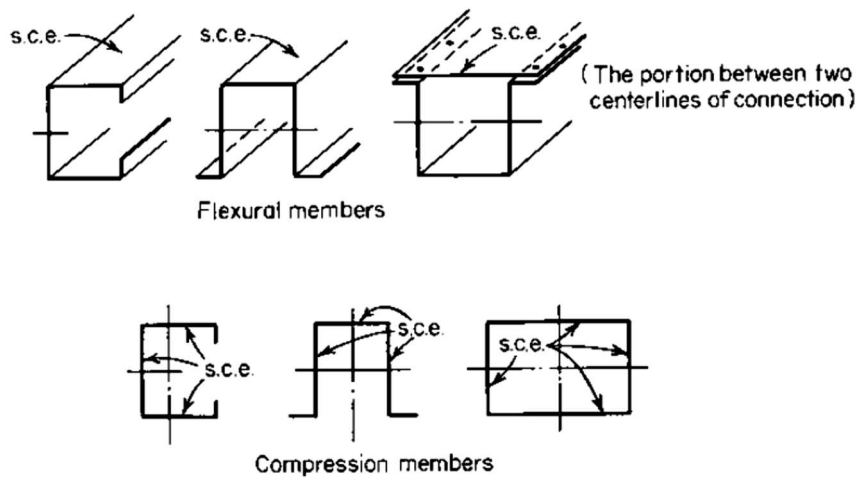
Elementos atiesados en perfiles estructurales [4]
